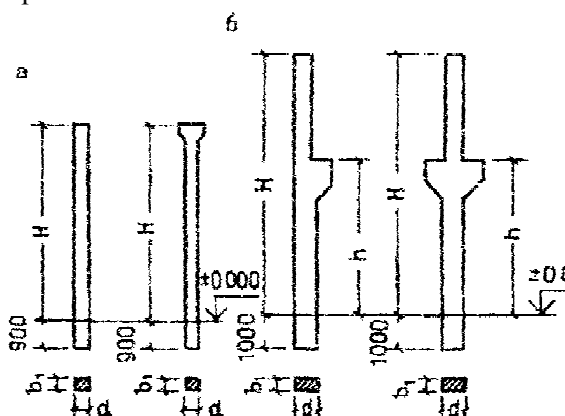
Сборные железобетонные колонны: а - одноветвевые для бескрановых зданий; б - одноветвевые для крановых зданий
